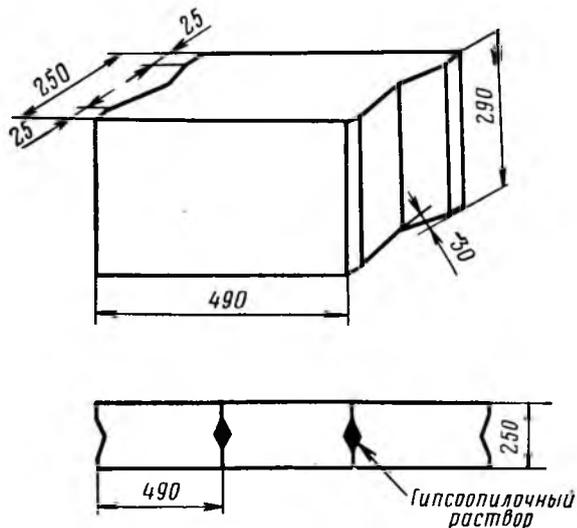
Гипсоопилочный стеновой камень и фрагмент стеновой кладки
